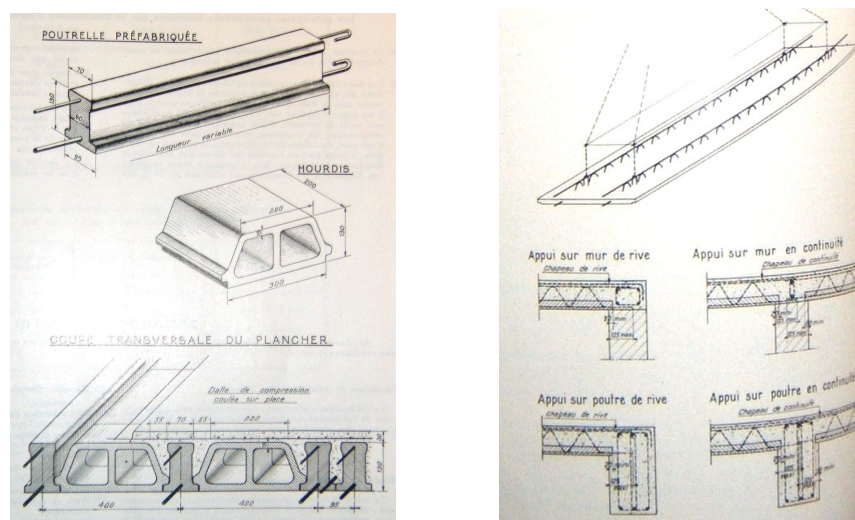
et 8. A gauche, plancher Sapi agréé par le CSTB en 1960; à droite prédalle Vibro béton agréée en 1964.
